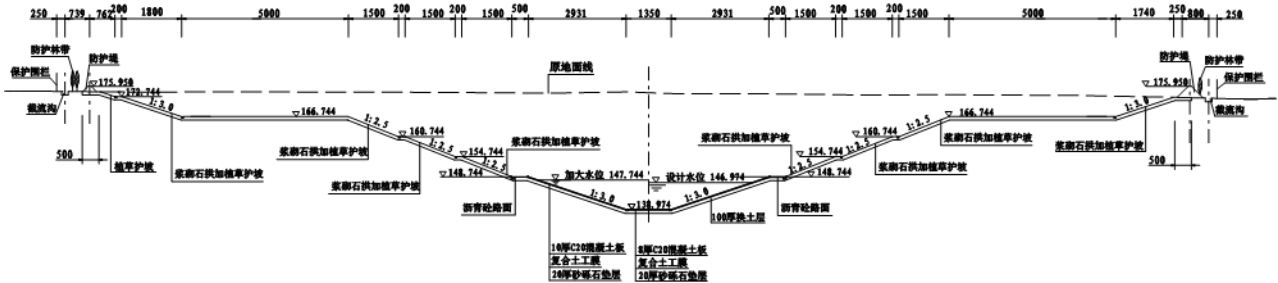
浙川段渠道深挖方断面示意图（单位：cm）
